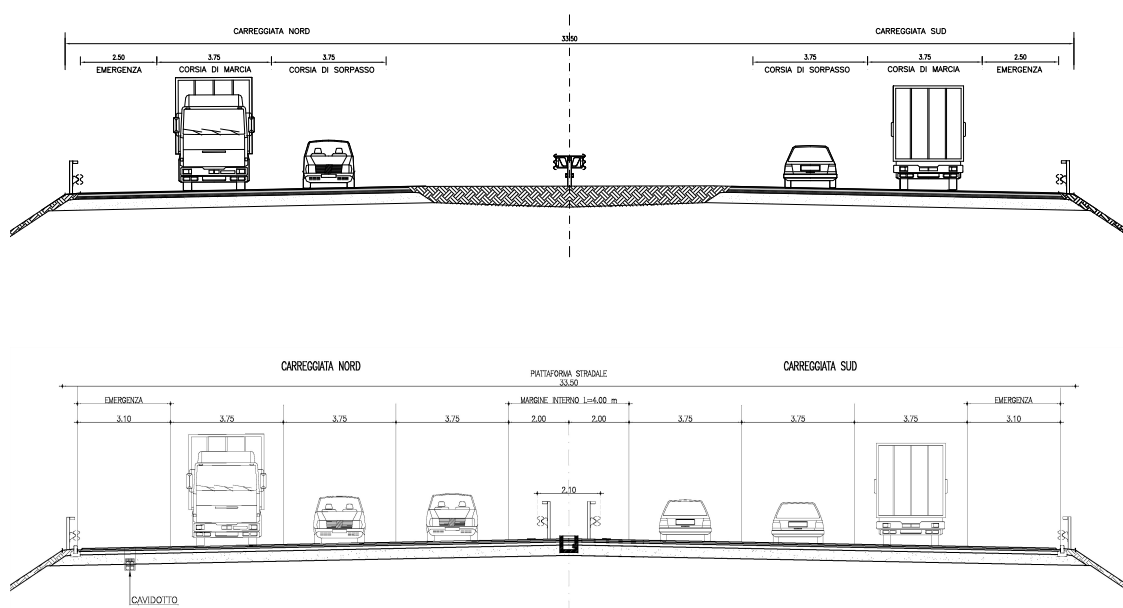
/4.2.4 – Sezione tipo attuale e di progetto
